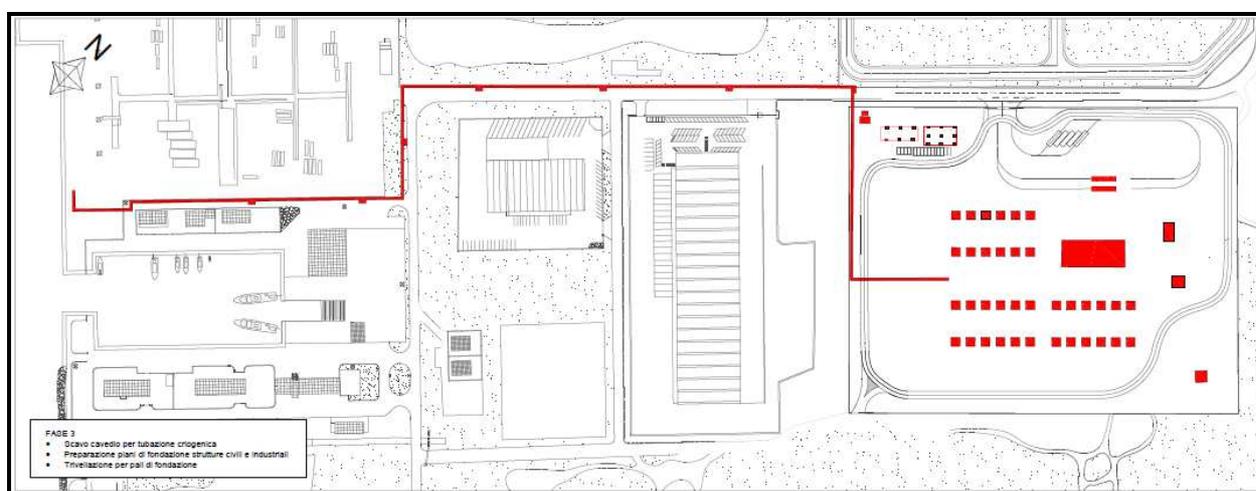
Fase 3. Area oggetto delle lavorazioni previste.
